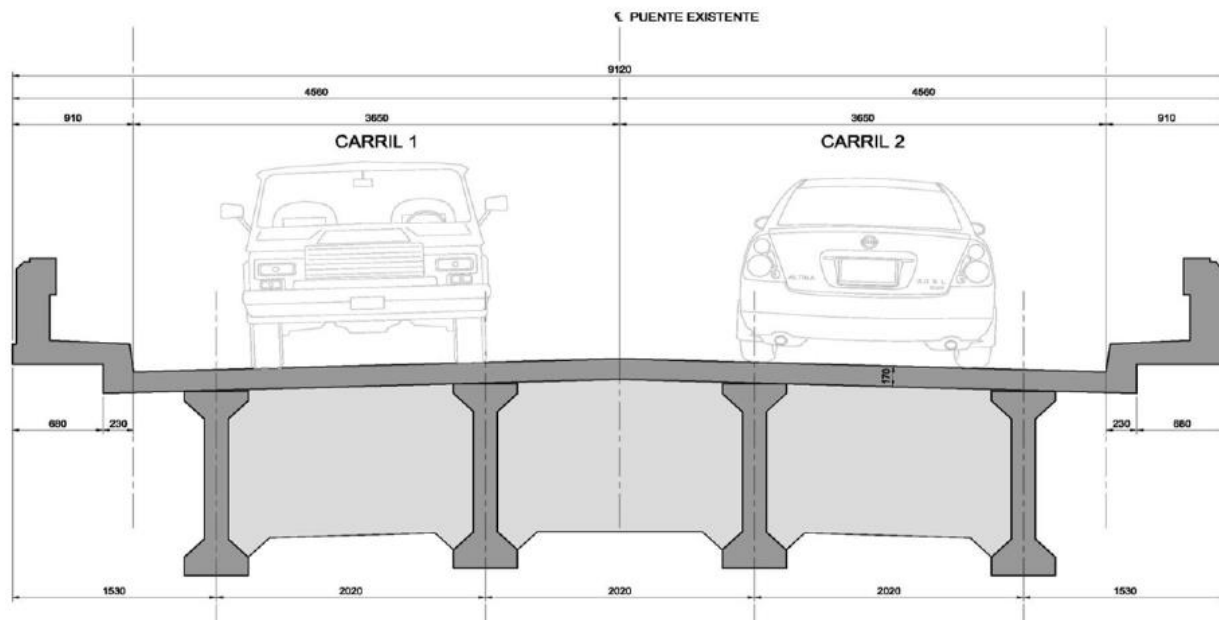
Sección transversal puente existente sobre el río Corrogres
